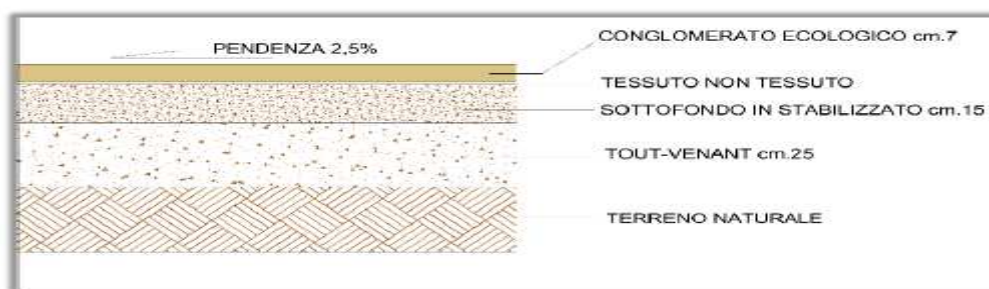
CARATTERISTICHE PAVIMENTAZIONI IN PROGETTO
